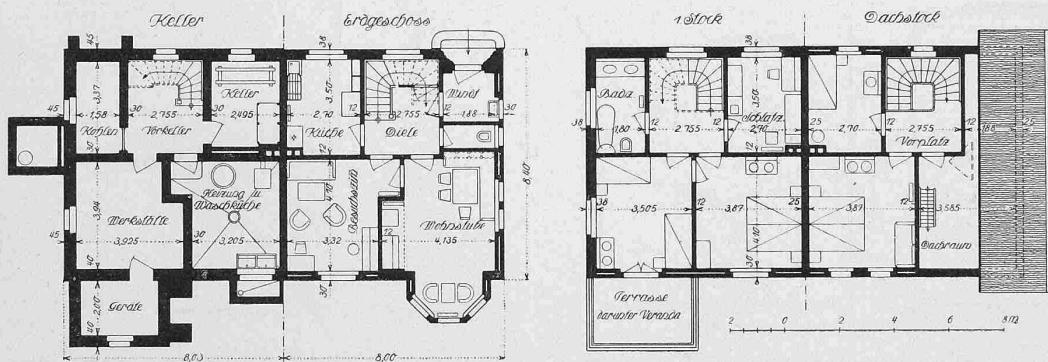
u. 21. Grundrisse zum Doppel-Einfamilienhaus (links Prof. Dr. Gasser) zu je sieben Zimmer. — 1:250.
